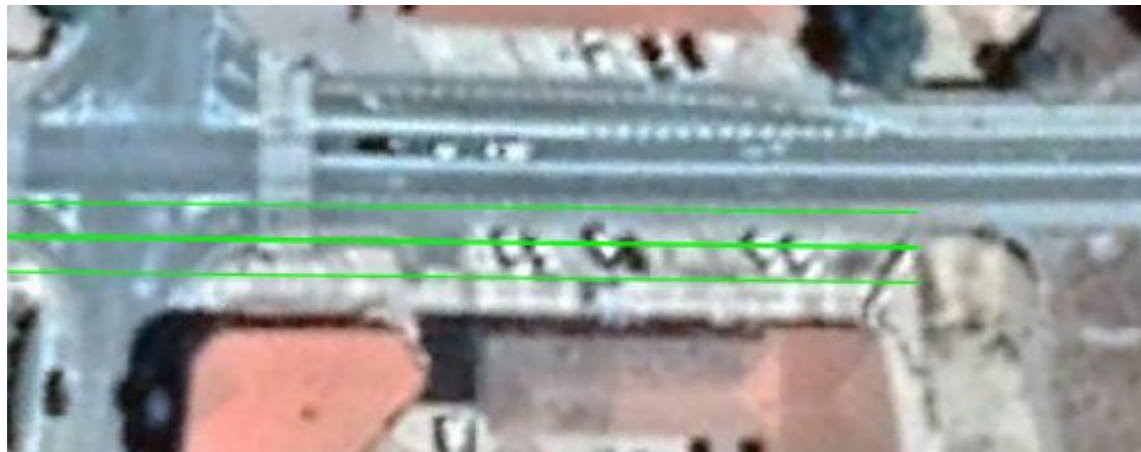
Detalle desembocadura en planta. Fuente: propia.
